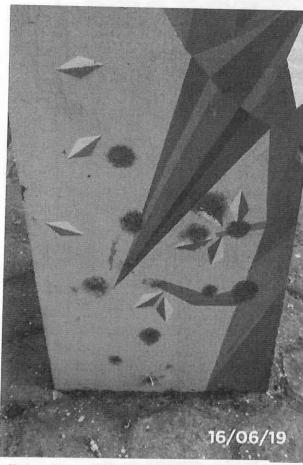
Detalhe segregação do concreto, trincas, desplacamento do concreto do pilar, pontos aparentes de bolor, devido a infiltração de água no concreto
